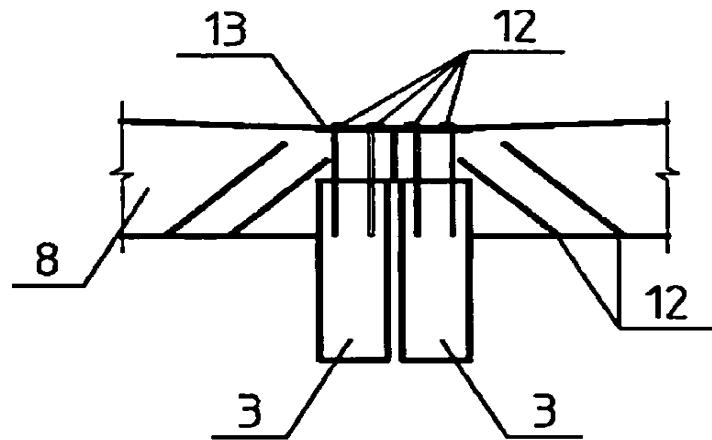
Соединение крупноразмерных двухскатных клееванерных плит с верхним поясом деревометаллической фермы с помощью накладки с крепежными элементами
